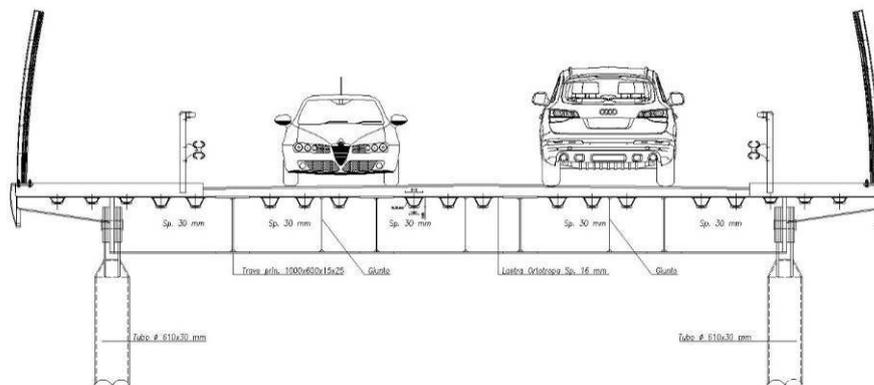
Sezione trasversale del nuovo sovrappasso n. 68
